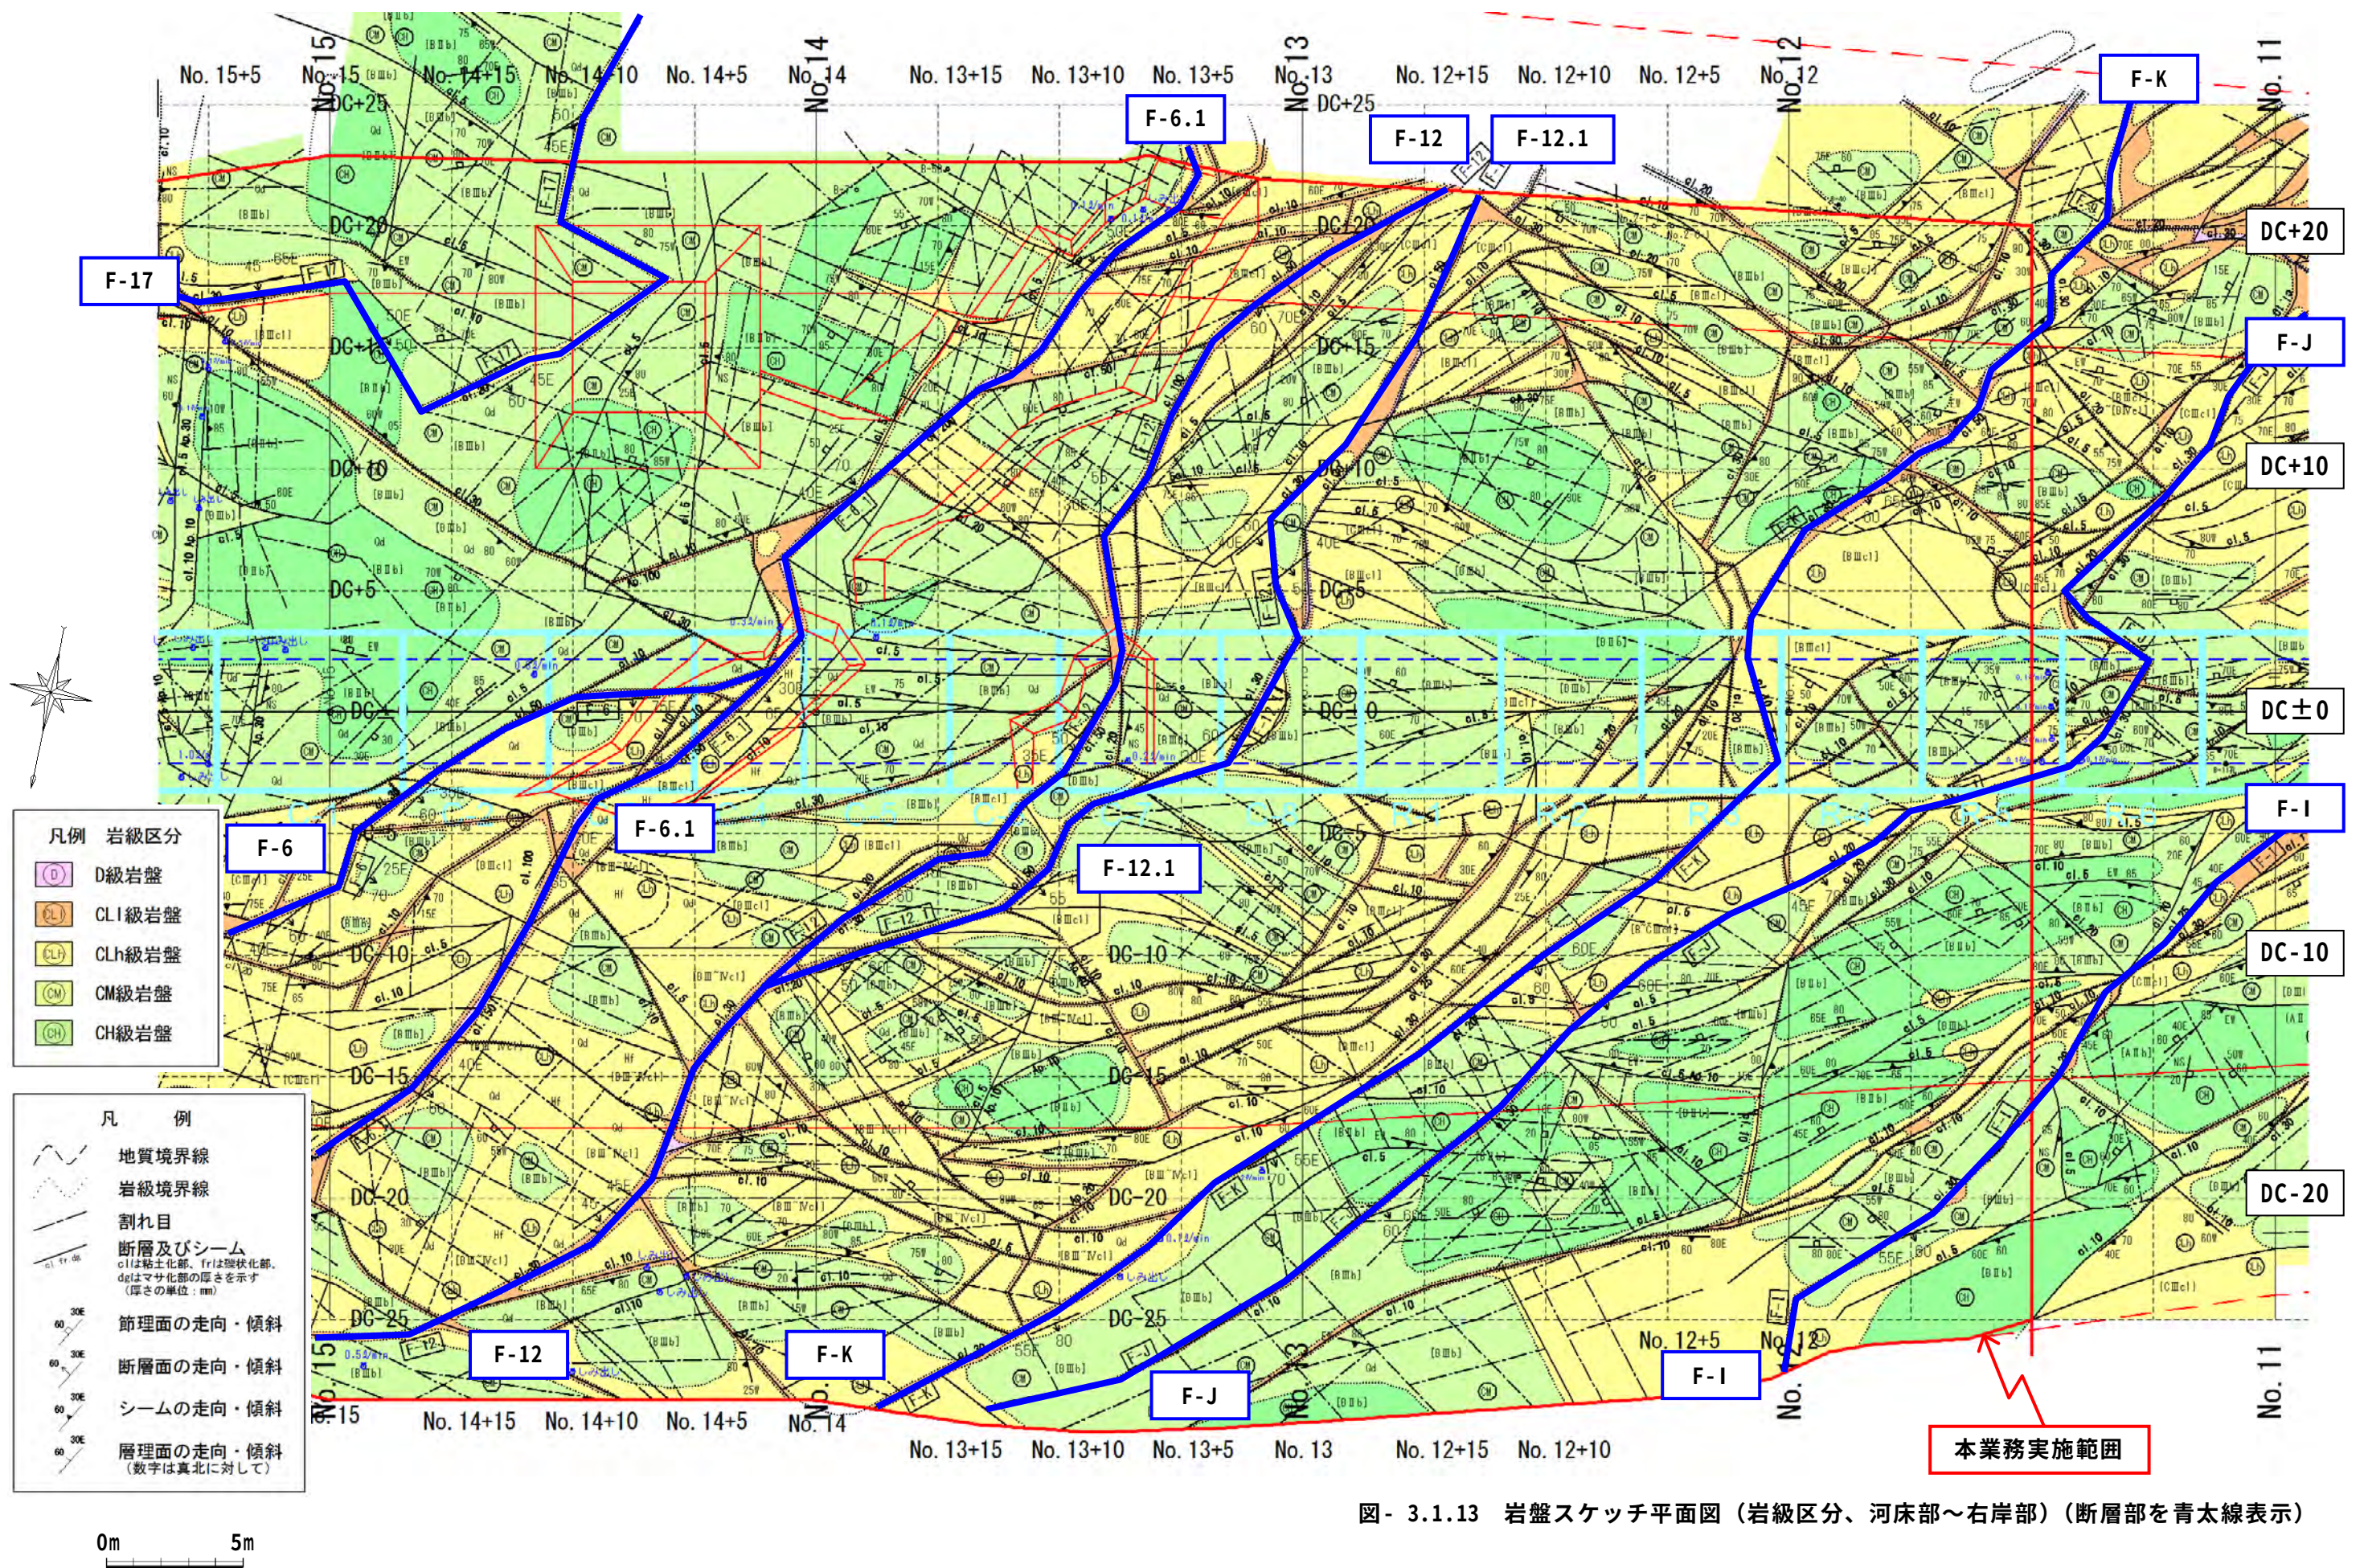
岩盤スケッチ平面図 (岩級区分、河床部～右岸部) (断層部を青太線表示)
